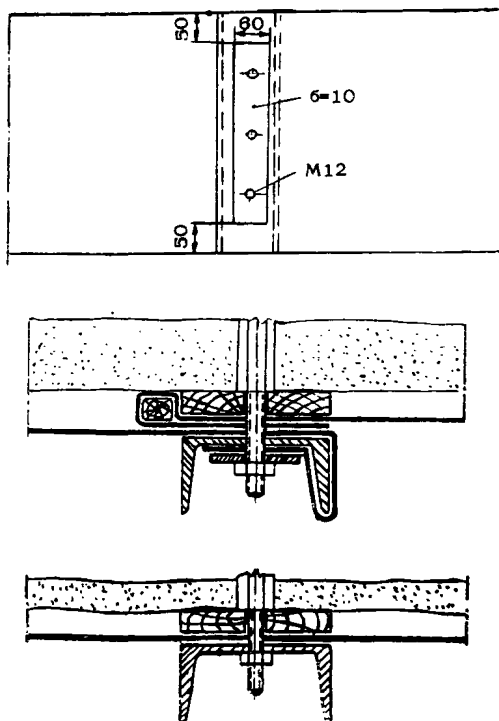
Схемы соединения полос стеклопластикового ограждения при креплении железобетонных рамных и анкерных крепей
